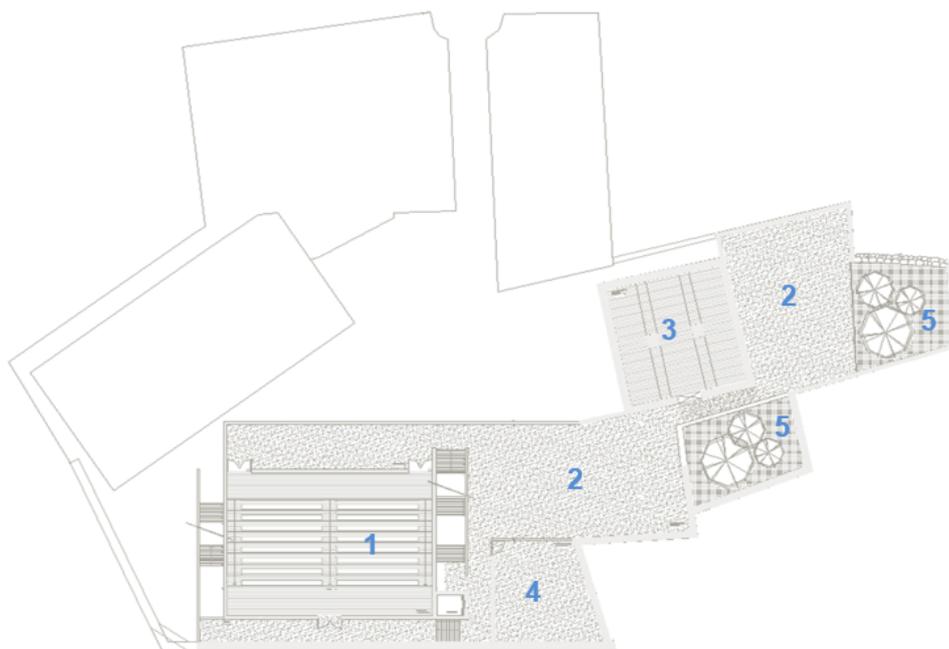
Planta da nova proposta do piso -1 (sem escala)
